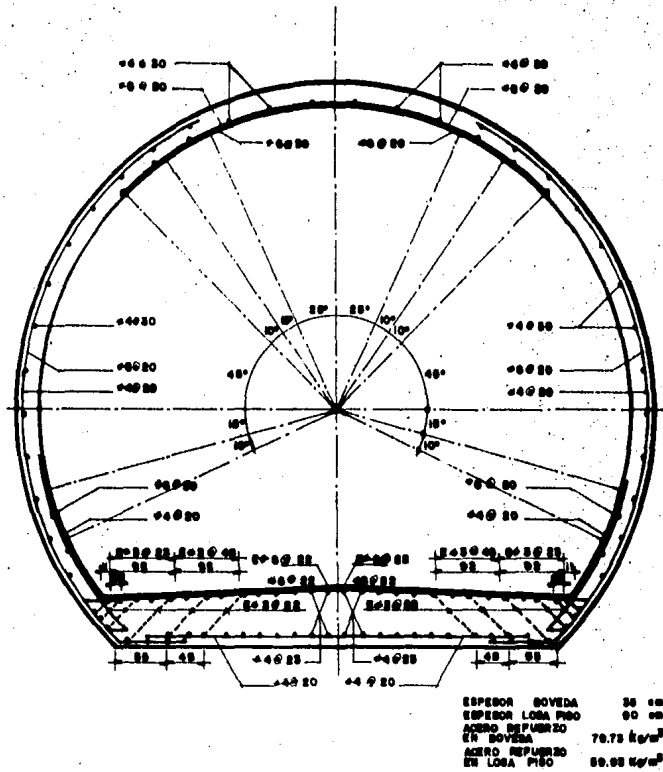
ESPEJOR Y ACERO DE REFUERZO
